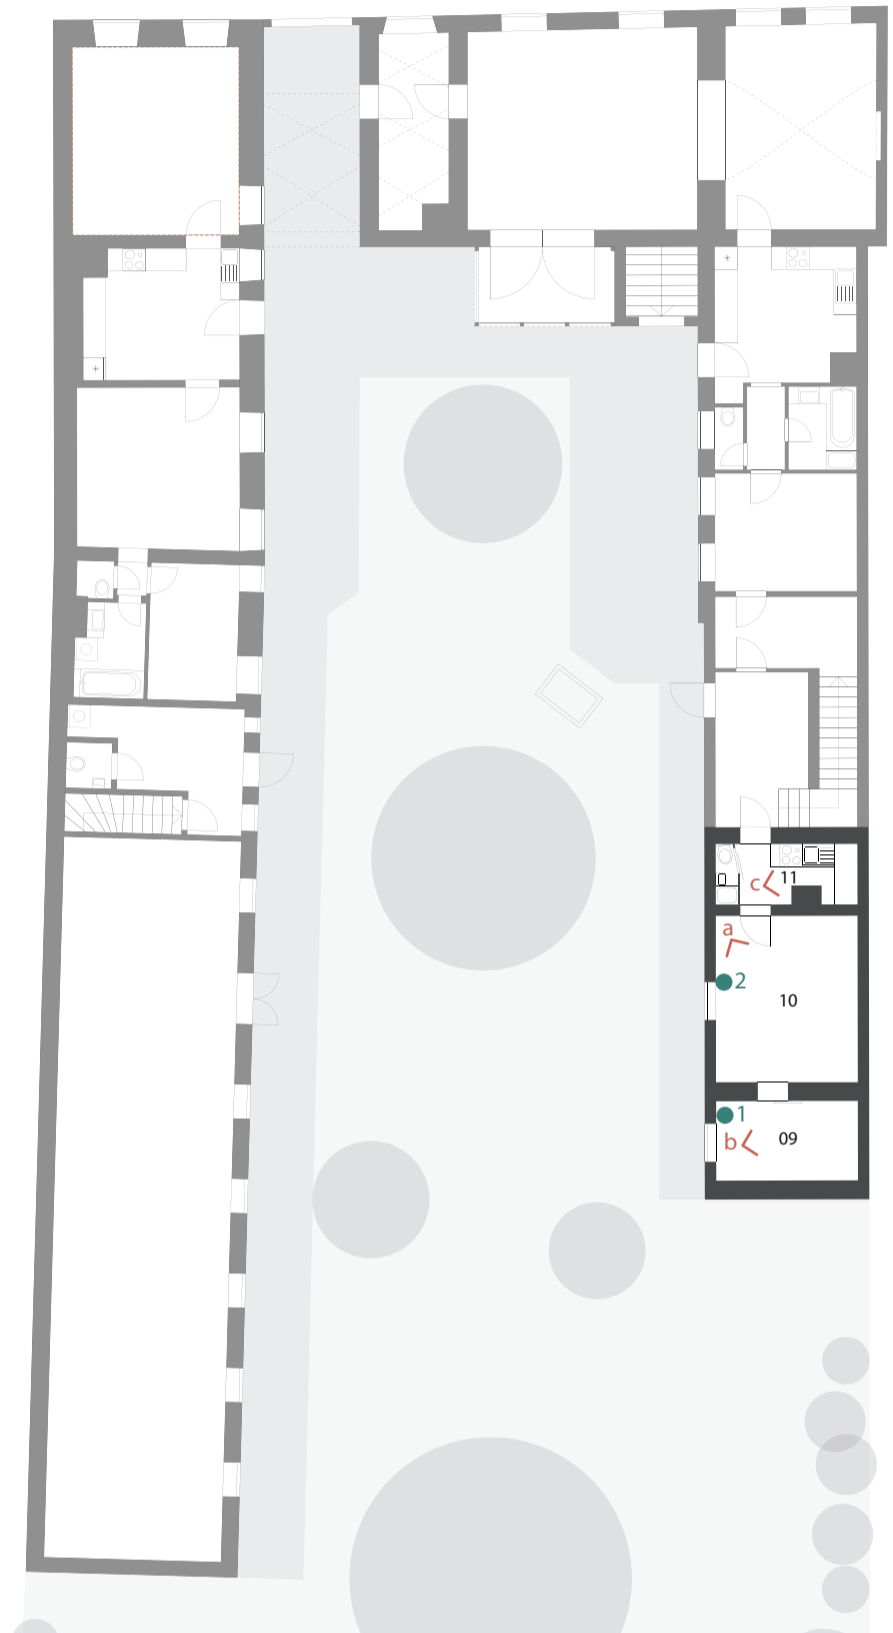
Grundriss Erdgeschoß | M 1:200 | Raum 09, 10, 11
